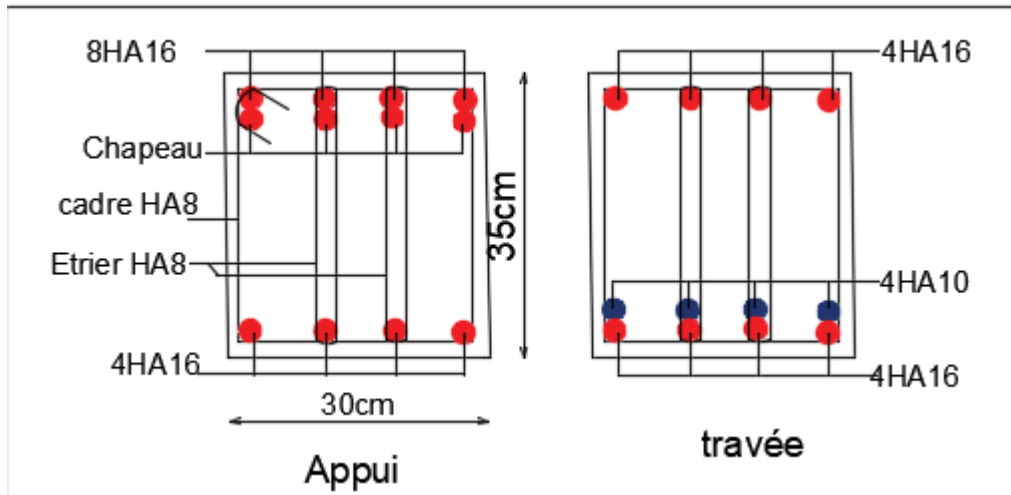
Schéma de ferrailage de la poutre secondaire du plancher étage 5
